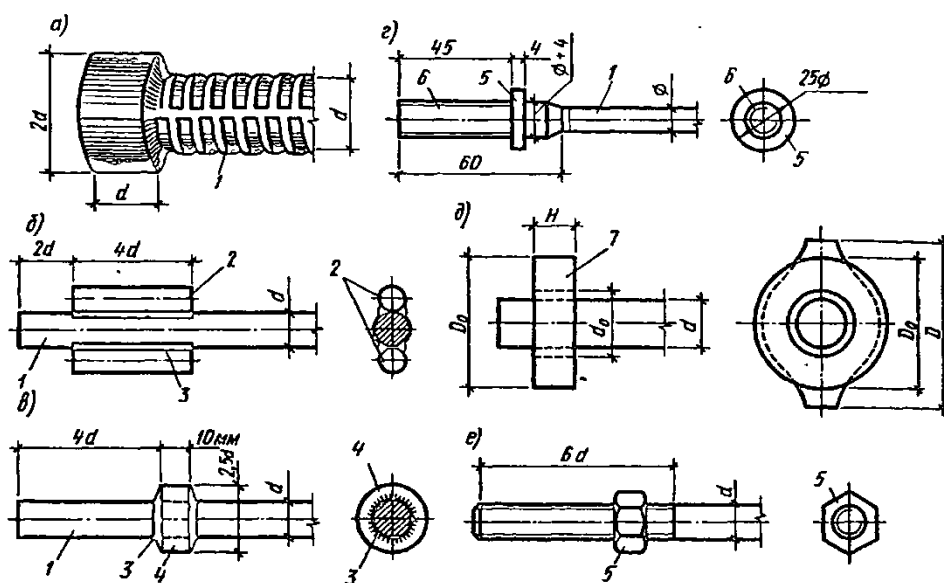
Анкерные приспособления: а) высаженная головка; б) приварка коротышей; в) приварка кольца; г) нарезной наконечник с гайкой; д) обжатая шайба; е) нарезной конец с гайкой; 1 — арматурные стержни; 2 — коротыши; 3 — сварочной шов; 4 — кольцо; 5 — гайка; 6 — стальной штампованный наконечник с нарезкой, привариваемый к арматуре; 7 — обжатая шайба.
